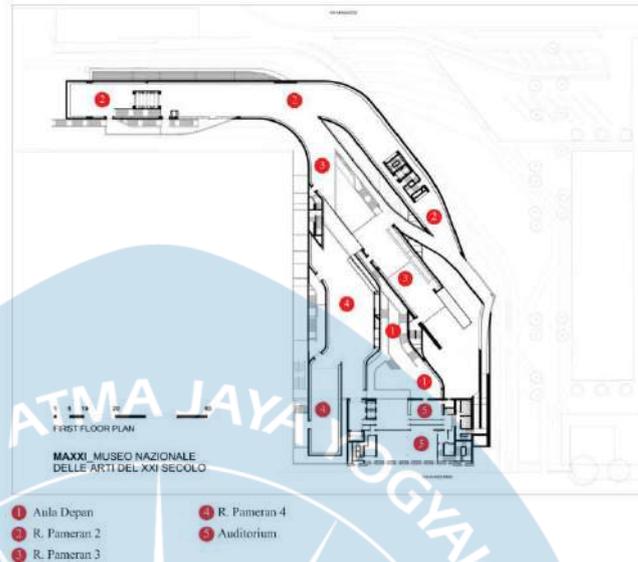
20 Denah lantai dasar beserta nama ruang
